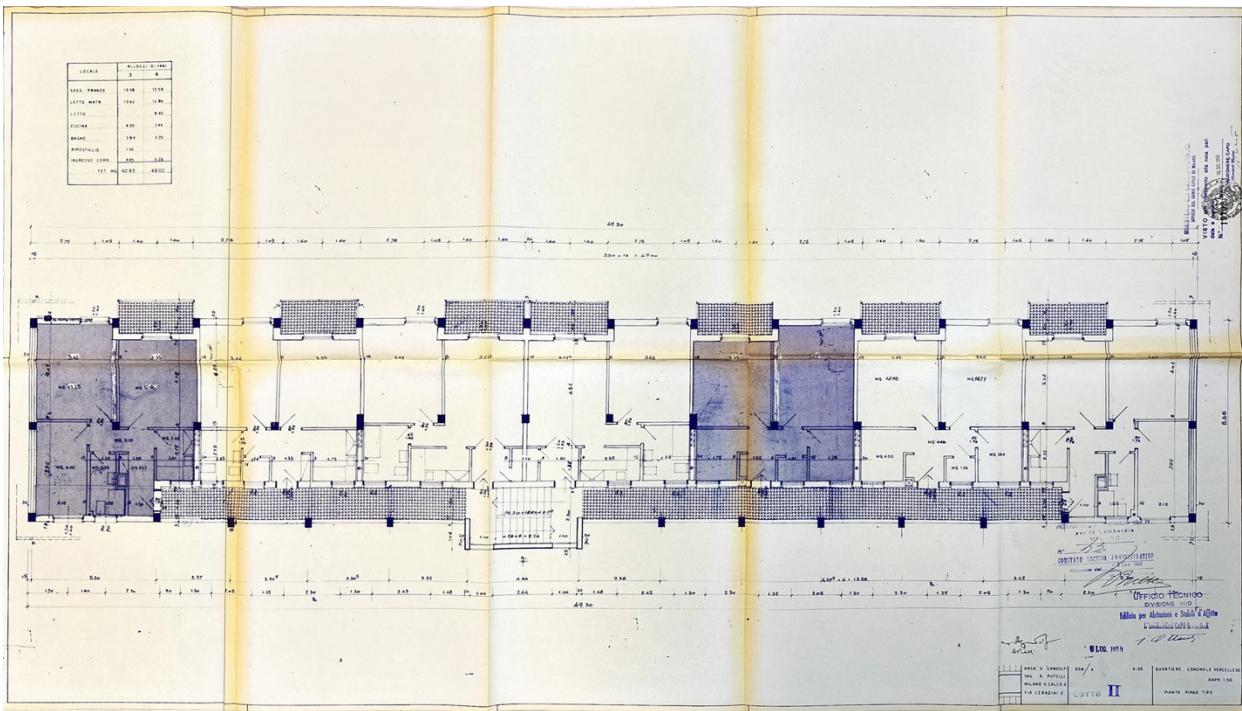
Milano, Quartiere comunale Vercellese, pianta piano tipo (redatto nel 1959), ACM, Ripartizione Servizi e Lavori Pubblici, fasc. 658/1965 (scansione L. Salis, 2025).
